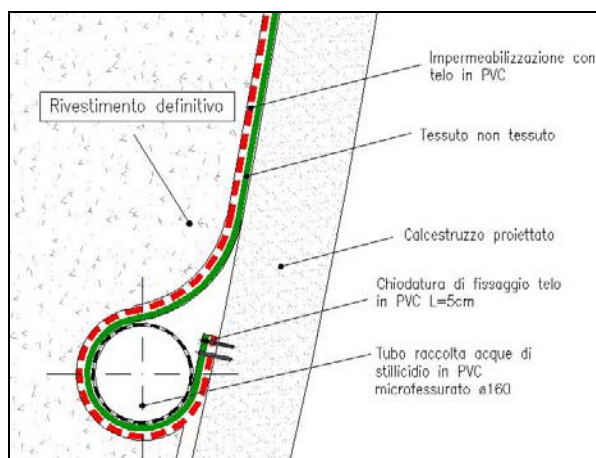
Sistema di drenaggio ed impermeabilizzazione n. 1.
